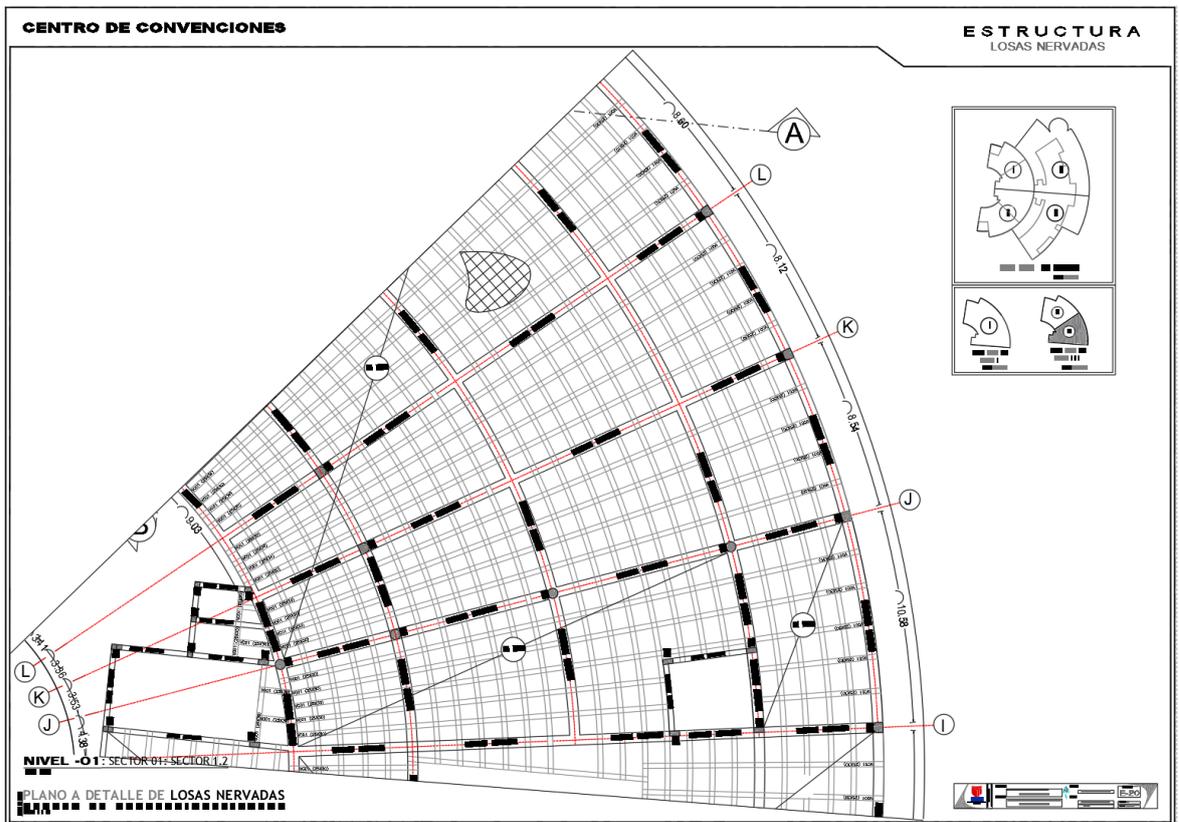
Plano a detalle de losa nervada del primer nivel: sector 01: sector 1.1.
